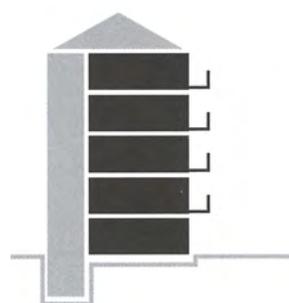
Systemschnitt Mehrgeschoßwohnbau (Netsch 2015, 88)
